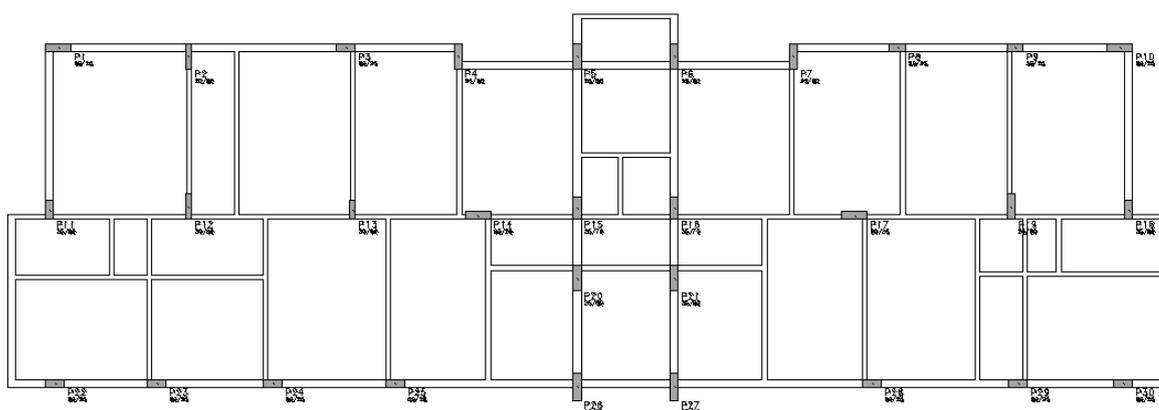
Planta de fôrmas do pavimento tipo - Modelagem S/BALAN-8PAV
